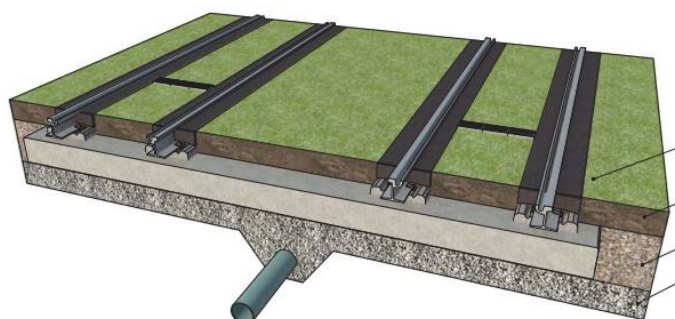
Konstrukce se dvěma oddělenými paralelními betonovými nosníky [2]
